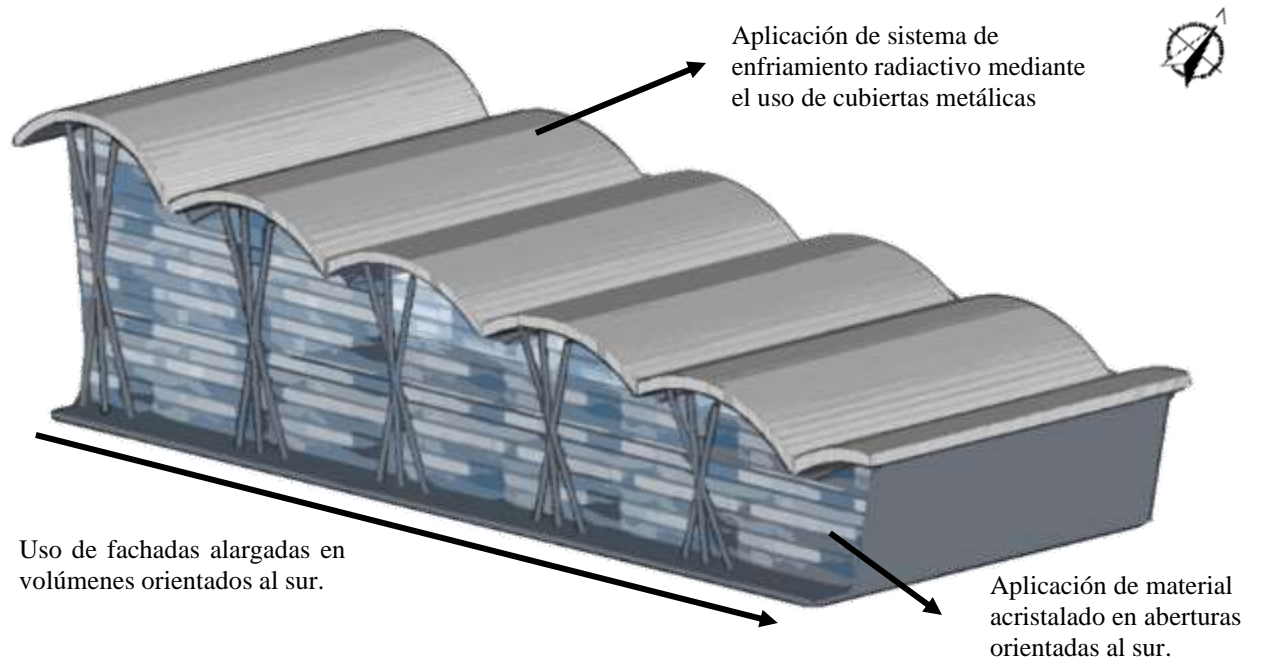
Representación de fachadas alargadas, cubiertas metálicas y material acristalado
